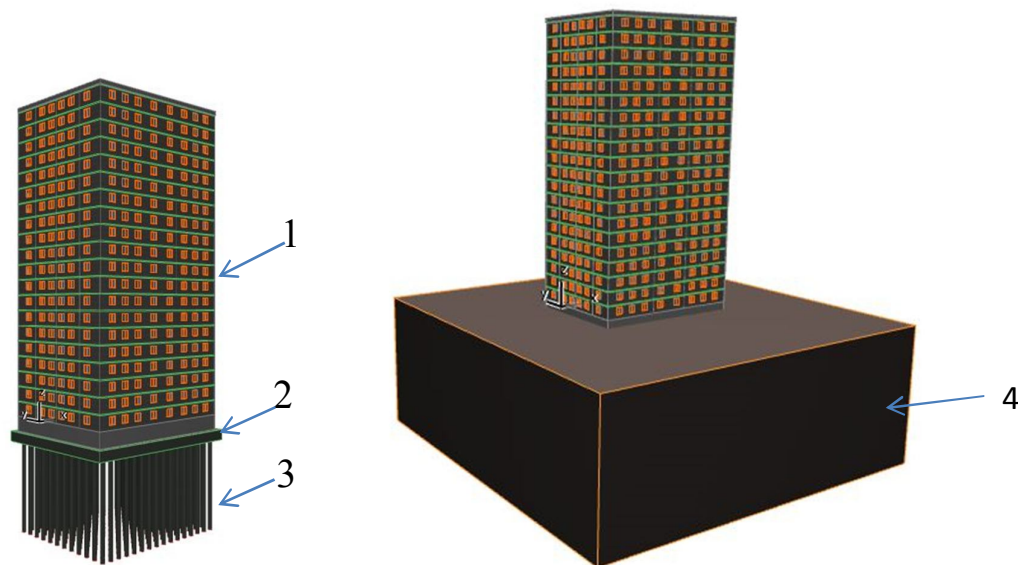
Расчетная схема системы «основание – фундамент – здание»
